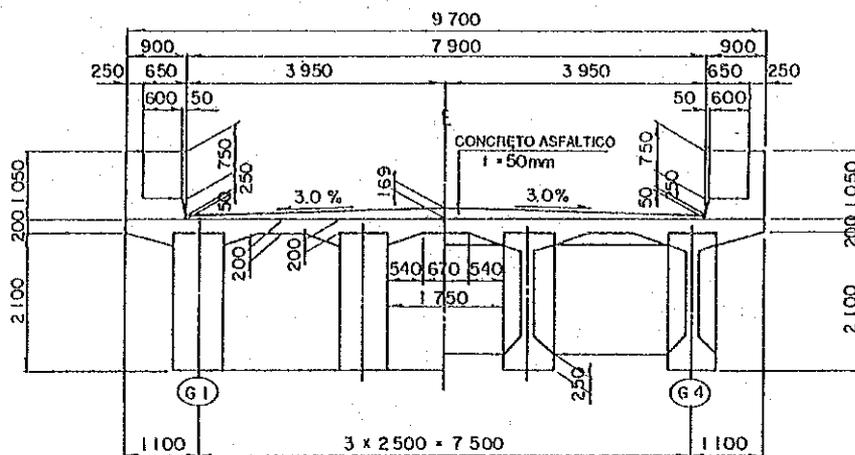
Sección de vigas simplemente apoyadas compuestas de CP
